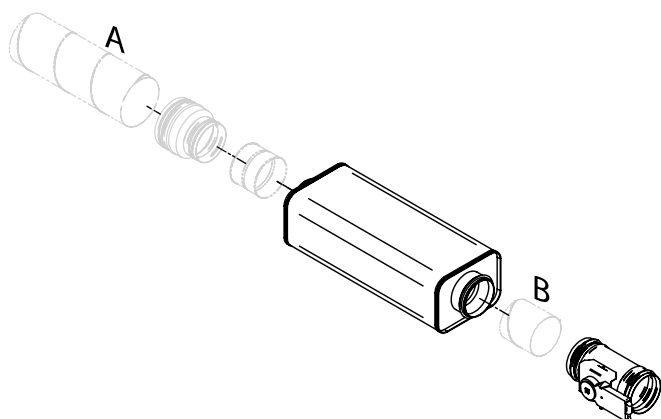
Kit d'air soufflé, PARAGON T-SAK-VAV-100
